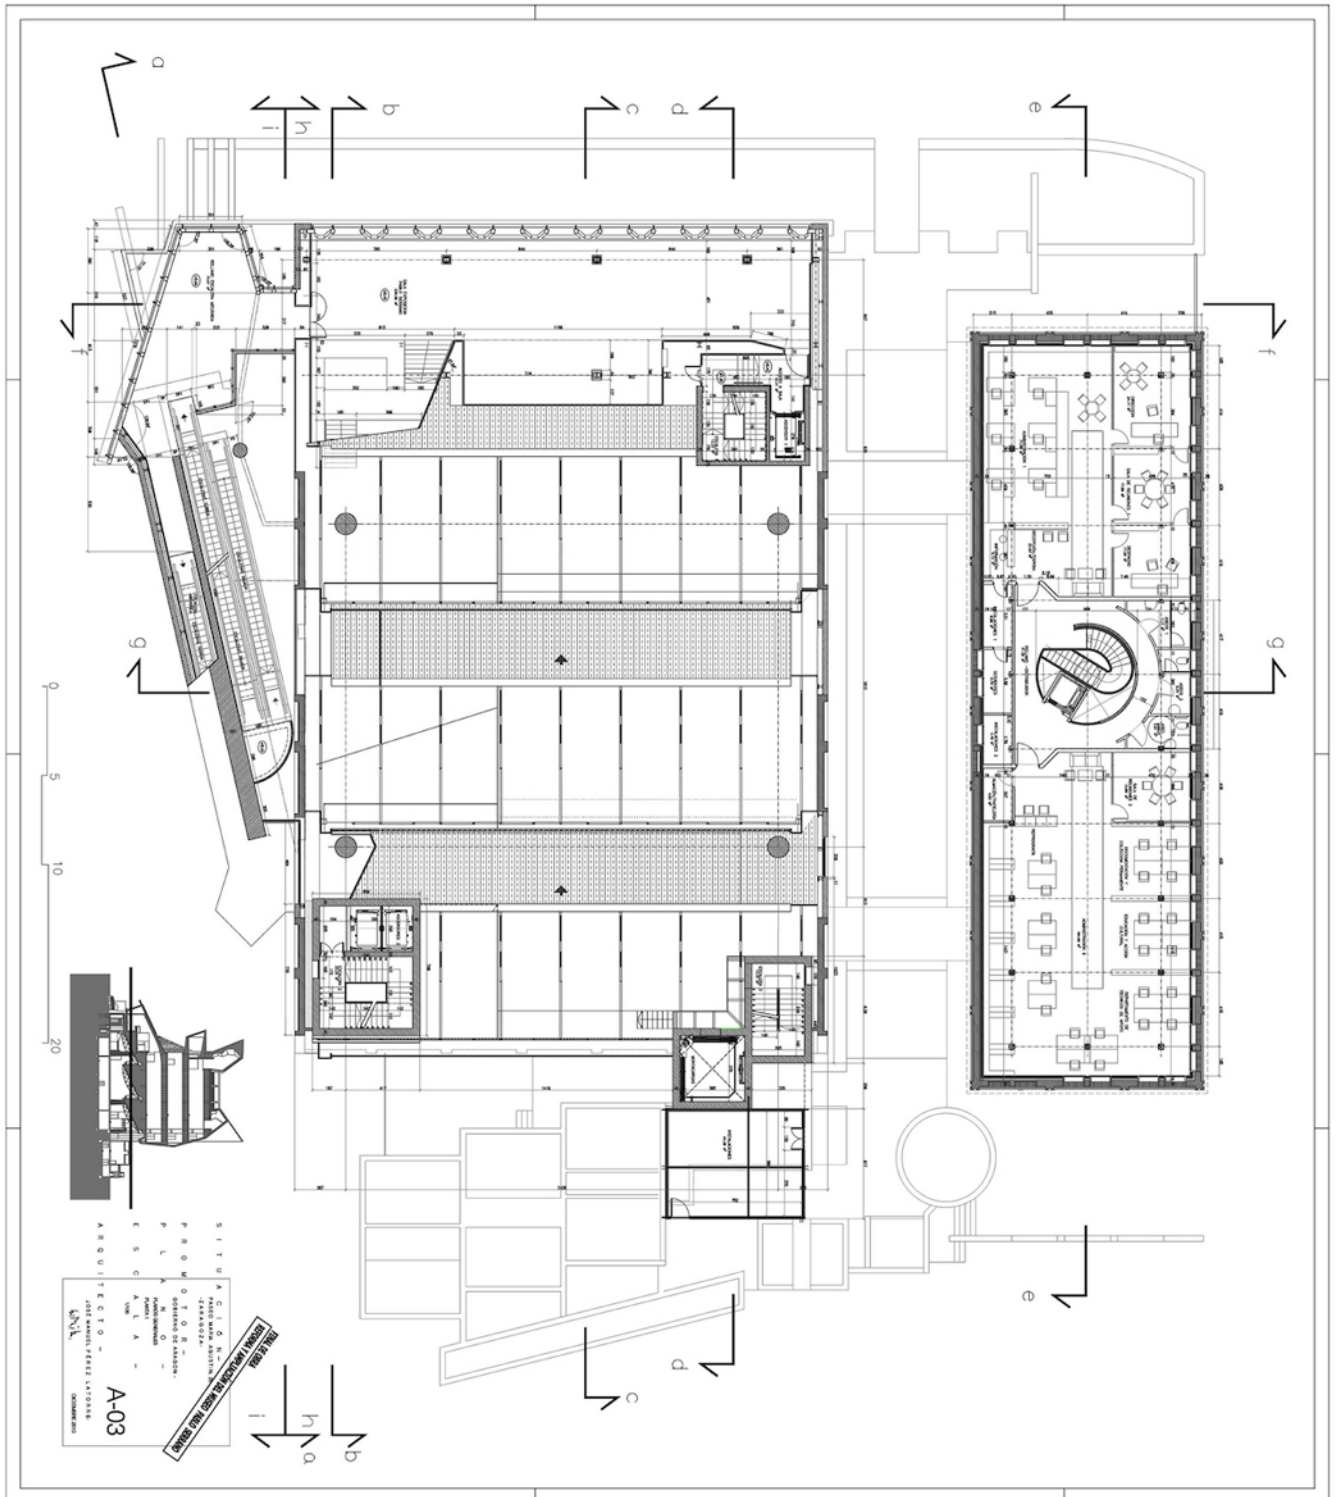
Planta primera (según J.M. Pérez Latorre)
